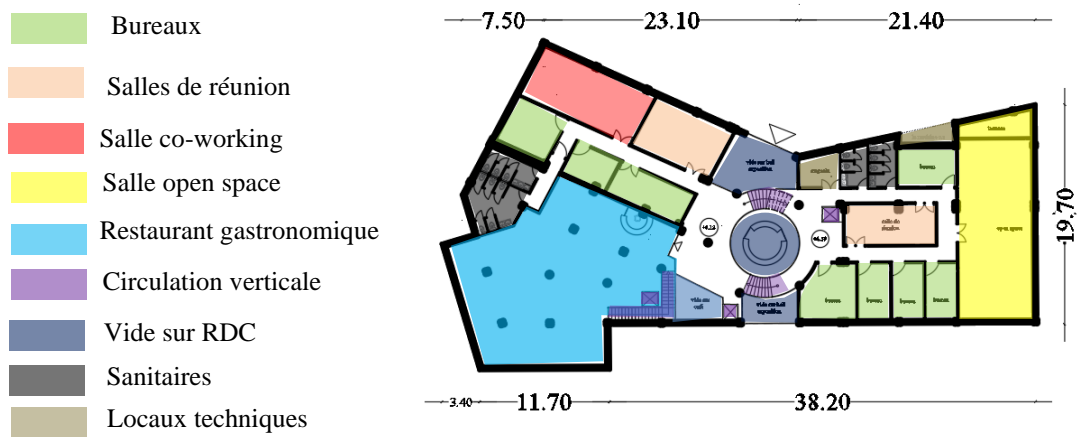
Plan R+1 Affaire. (Source : Auteur)
